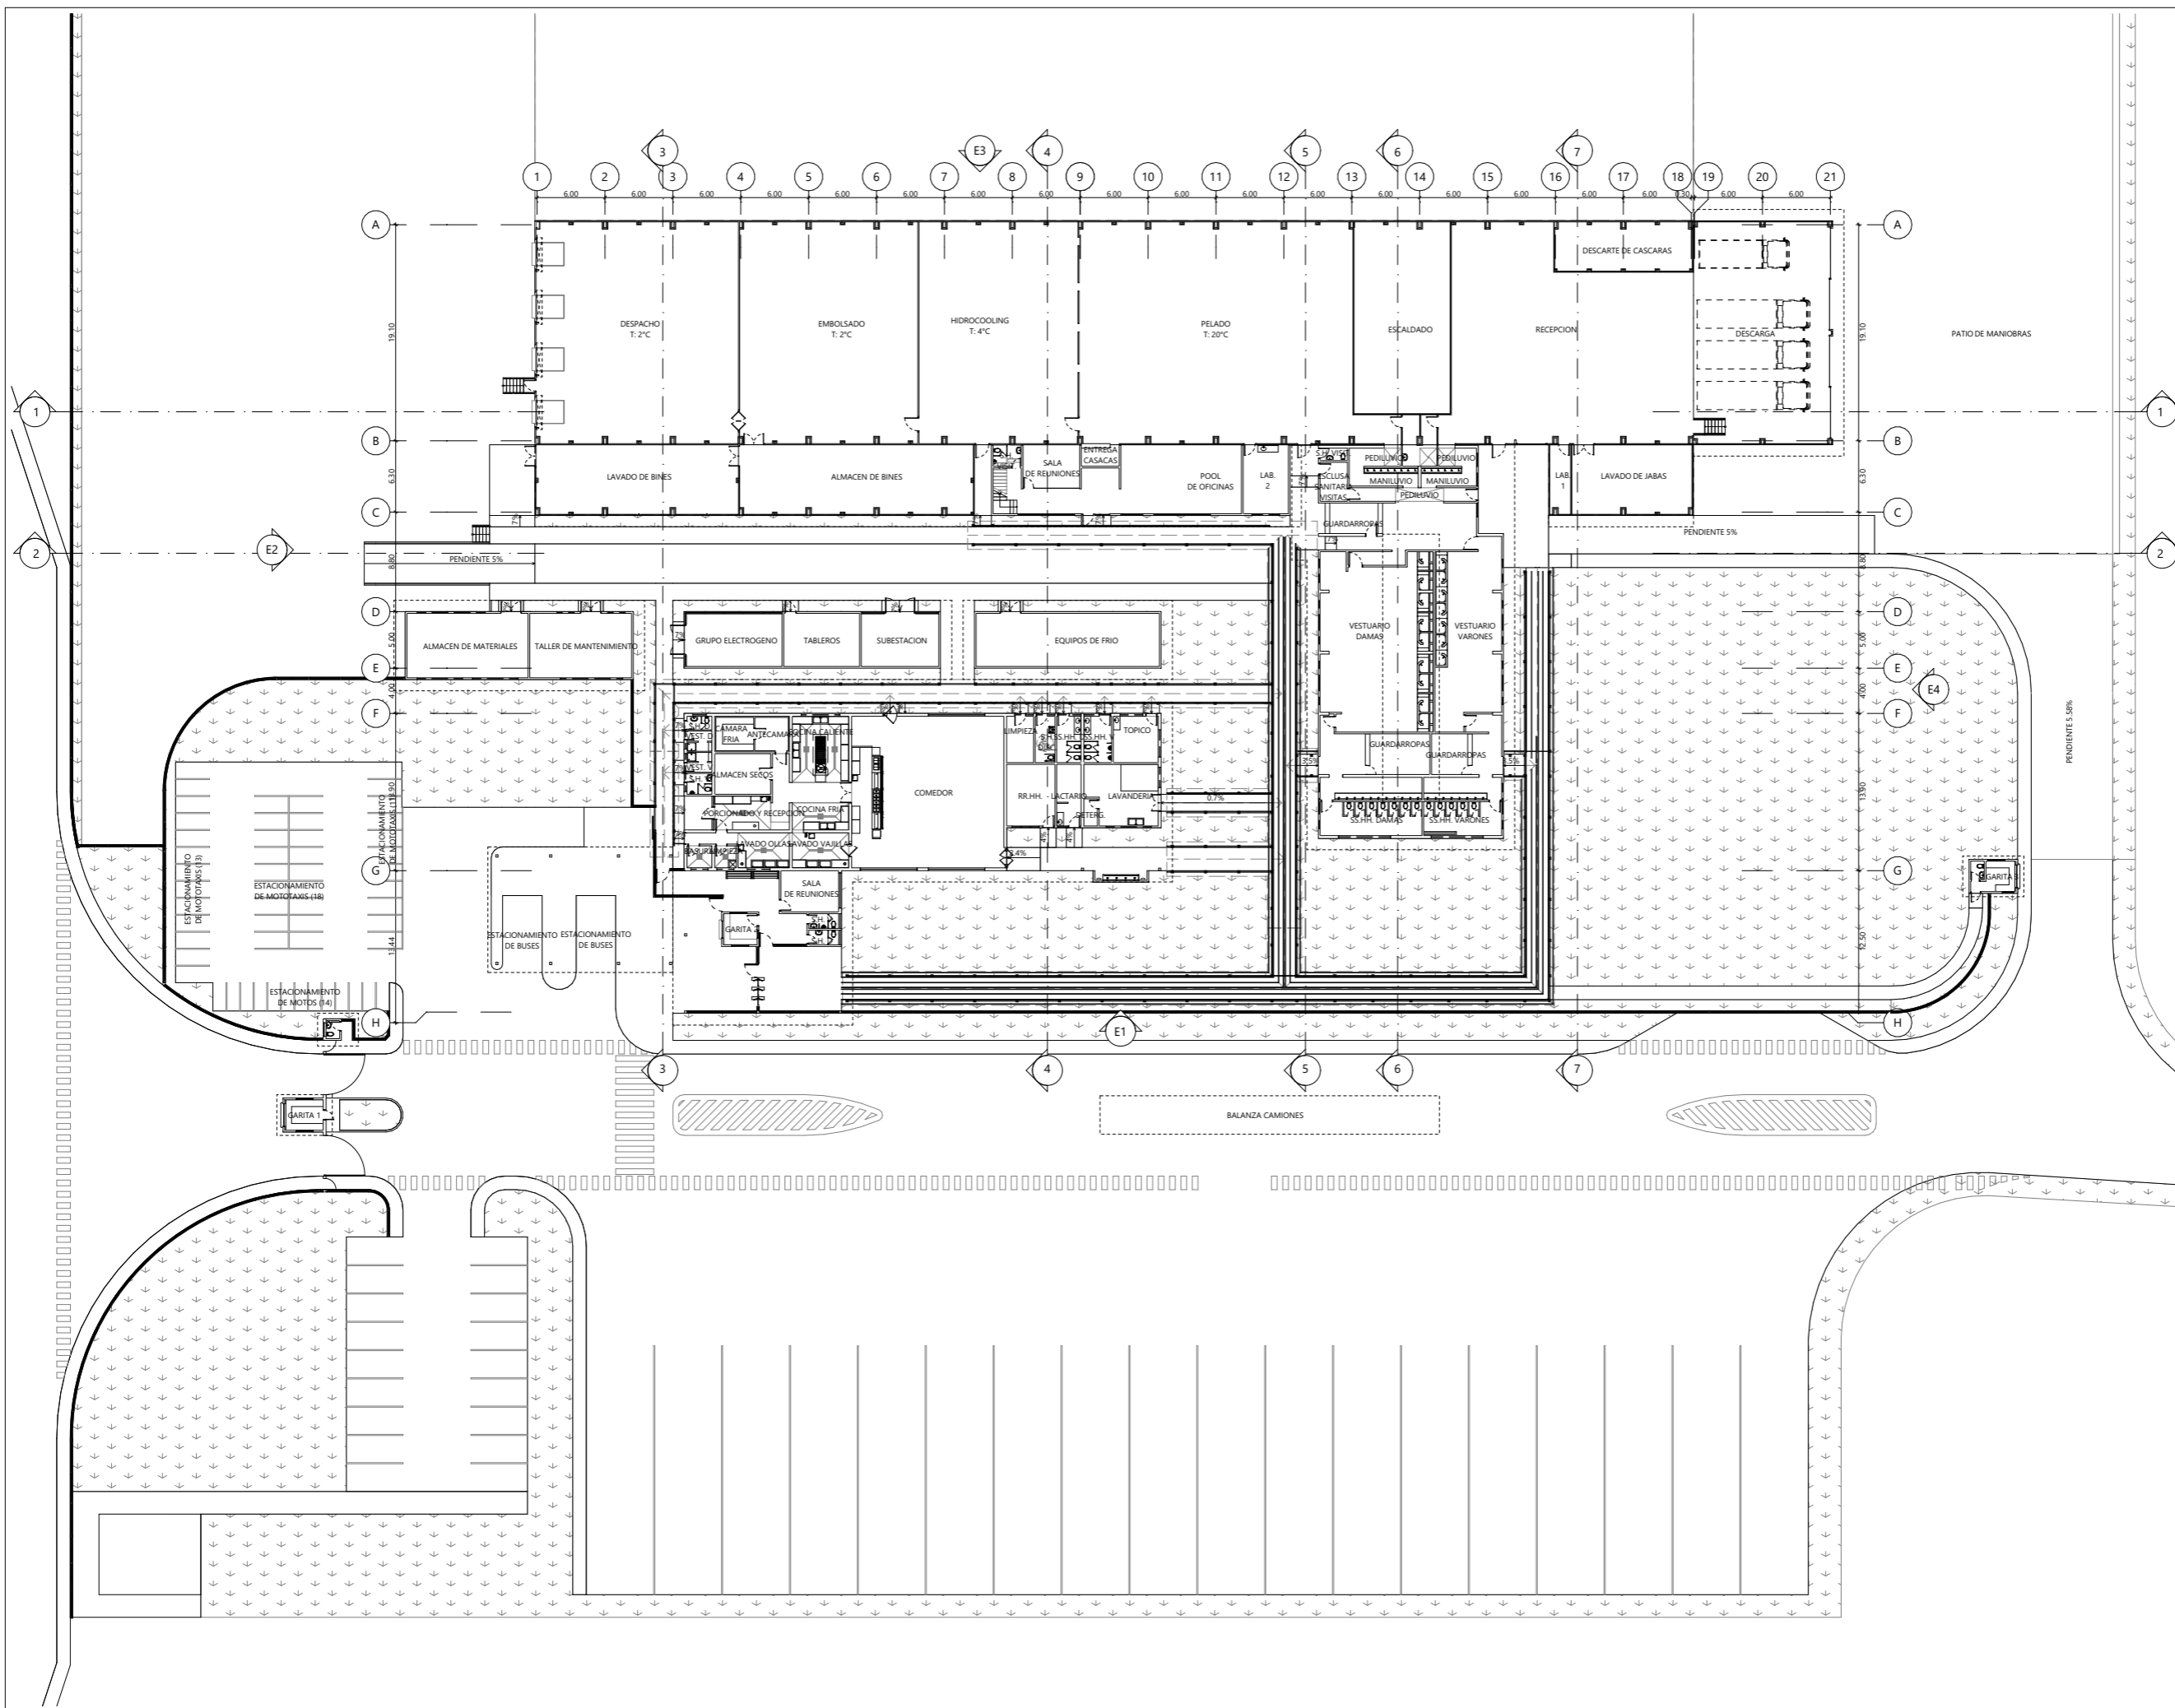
Planta de pelado y procesamiento de plátano – Vista aérea 1
